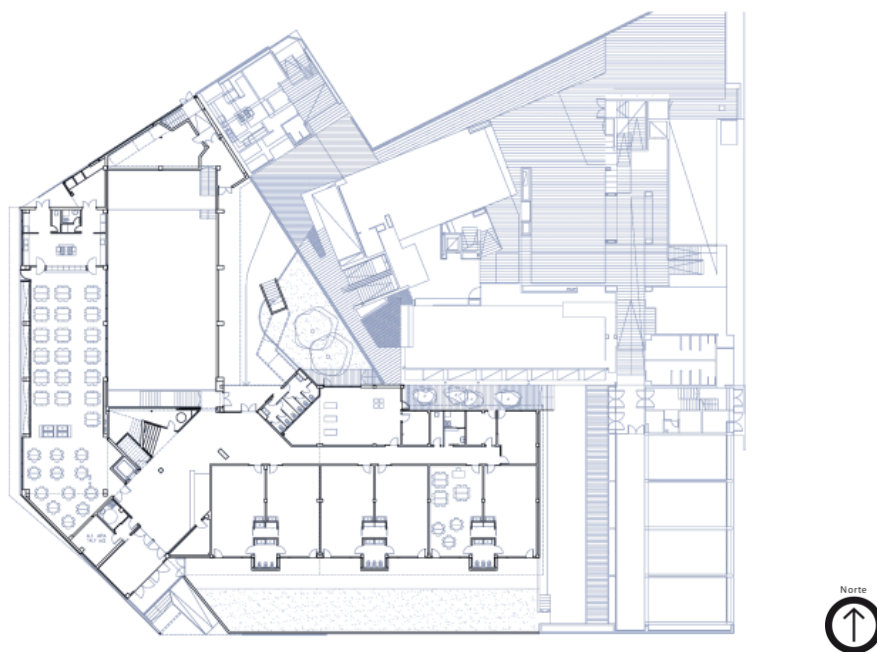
Planta Baja Fuente: SANTOS SÁ, 2012
